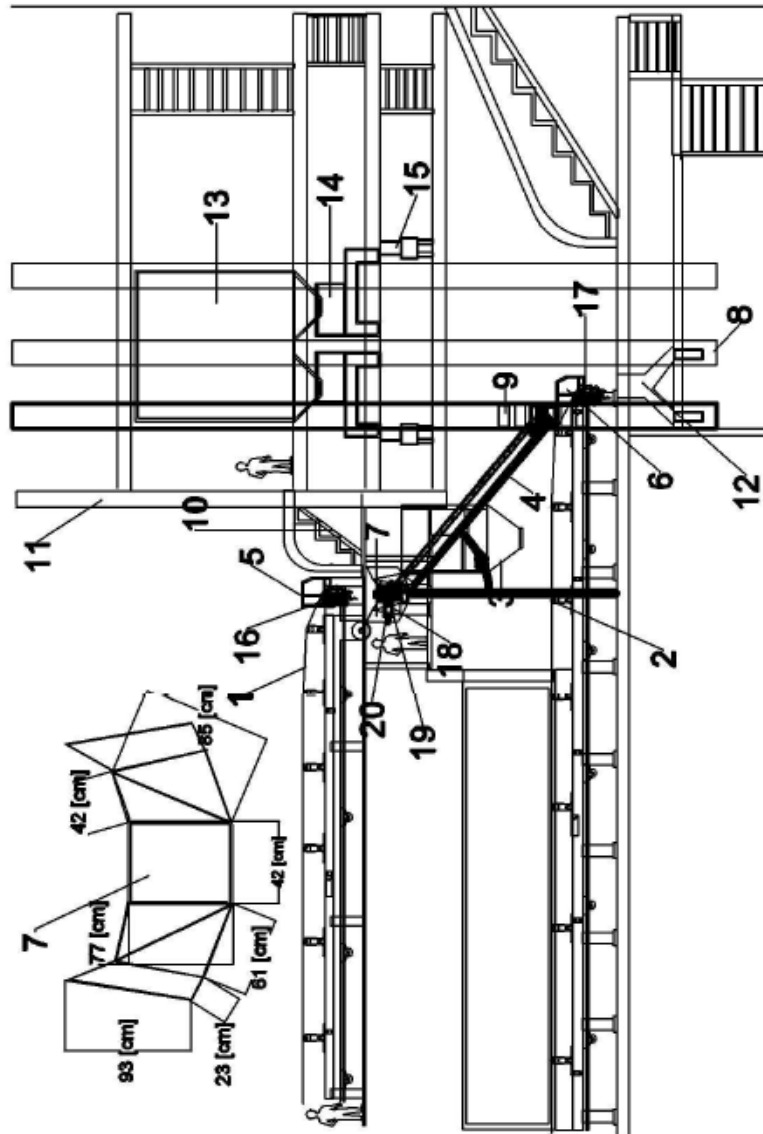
PLANO PARA INSTALACIÓN SISTEMAS BYPASS, (VISTA SUPERIOR).
